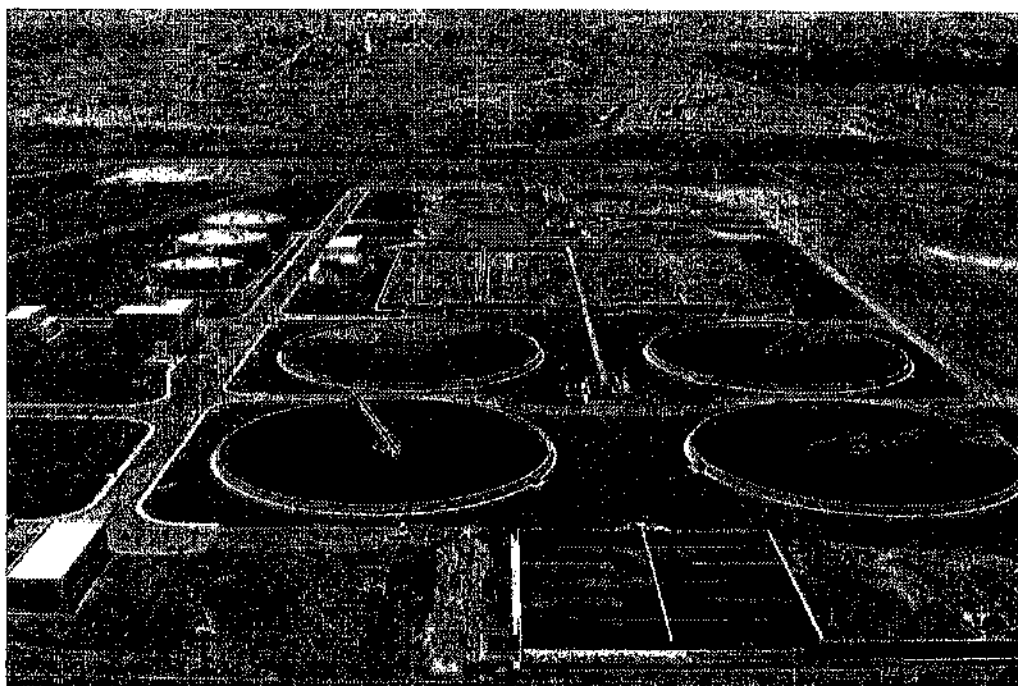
Imagen aérea de las Instalaciones de la planta sur
